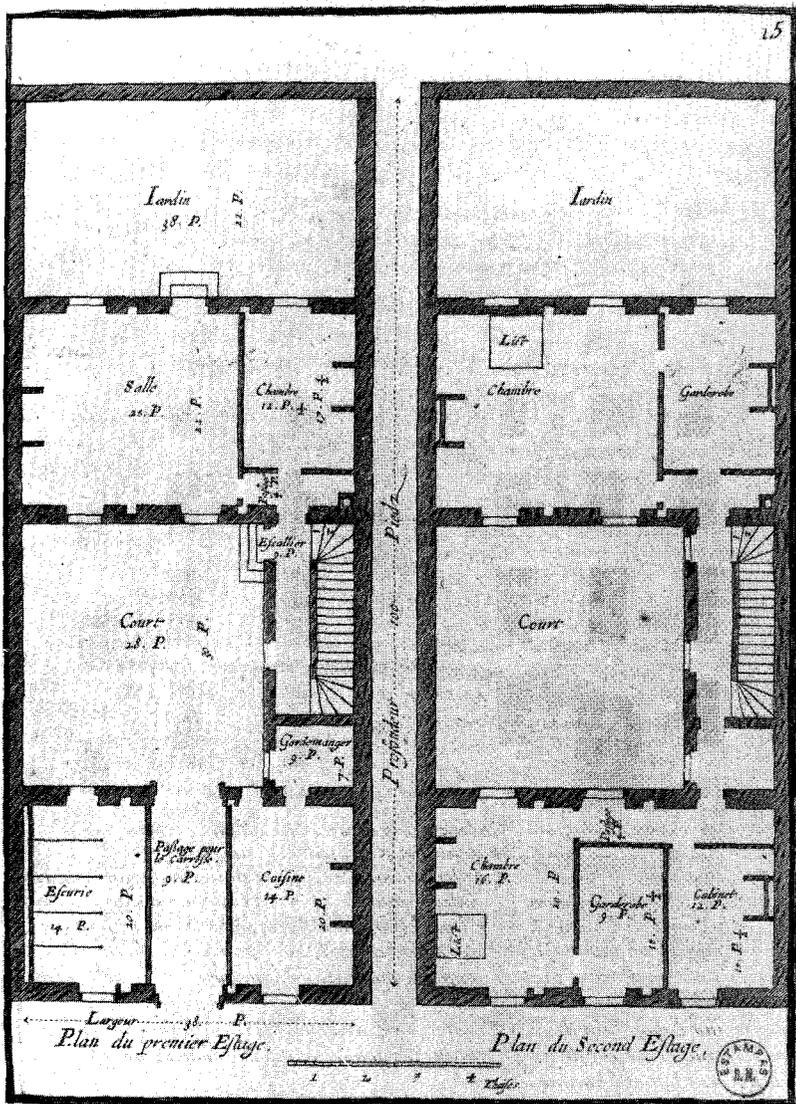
Pierre Le Mûet, Planta primera de una vivienda (1681).
